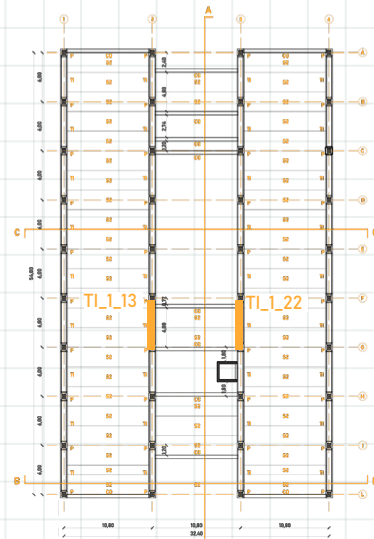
identificazione in pianta delle travi TI interpiano con M3 massimo
